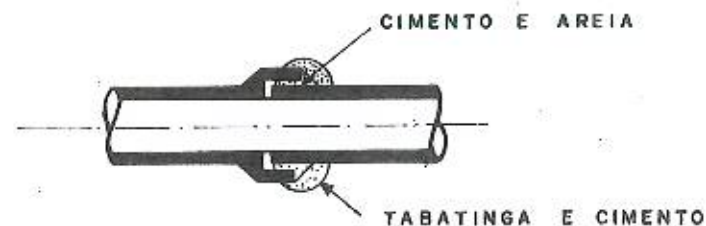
Proteção de uma junta com tabatinga e cimento.
